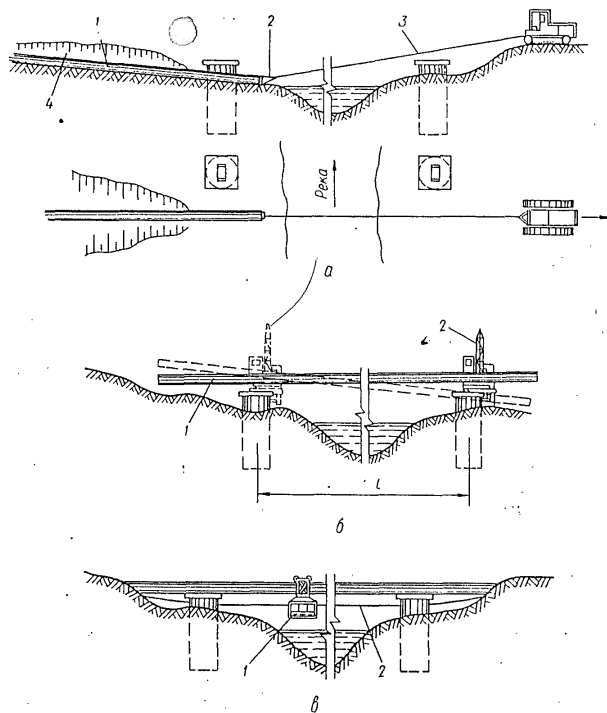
Самонесущий балочный переход. Монтаж секции трубопровода: а — протаскивание секции трубопровода; 1 — протаскиваемая секция трубопровода; 2 — заглушка со скобой; 3 — трос к трактору или лебедке; б — укладка секции трубопровода на опоры; 1 — укладываемая секция трубопровода; 2 — анкер или трубоукладчик; а — ремонт окраски трубопровода; 1 — подымаемая плеть для ремонта окраски трубопровода; 2 — временный трос для закрепления и продвижения плетки.
